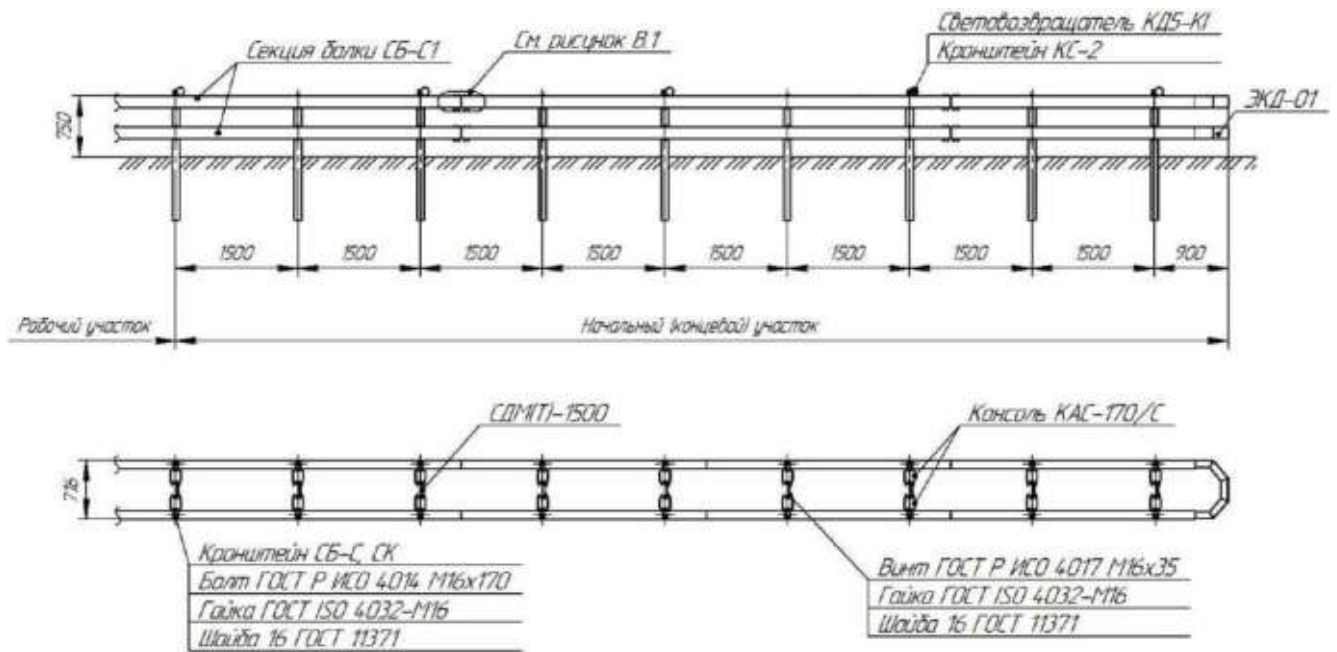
Схема сборки конструкции №6 (Изм. №1)
